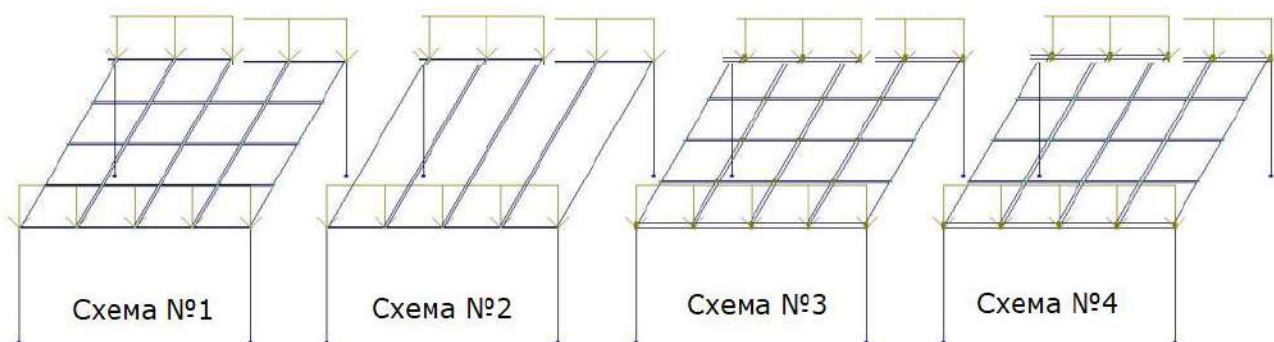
Способи моделювання збірних плит покриттів [3]: схема №1–перекриття-оболонка; схема № 2 – схема перекриття балка-стінка; схема № 3–оболонка по грані плит (об'єднання переміщень X та Y); схема № 4–перекриття-оболонка (KE 55)
